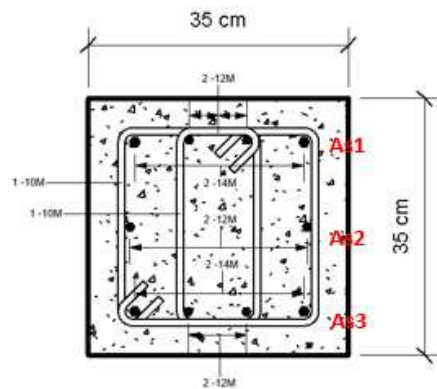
Armado de refuerzo de la columna (SMF) del sistema de 3 Pisos
